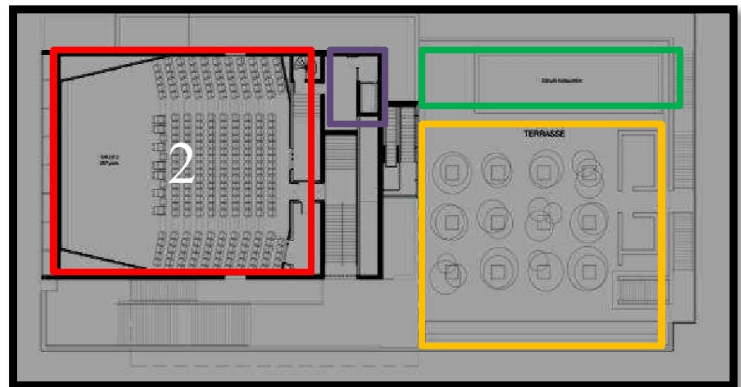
plan du 2 éme étage de la salle étoile de lilas
